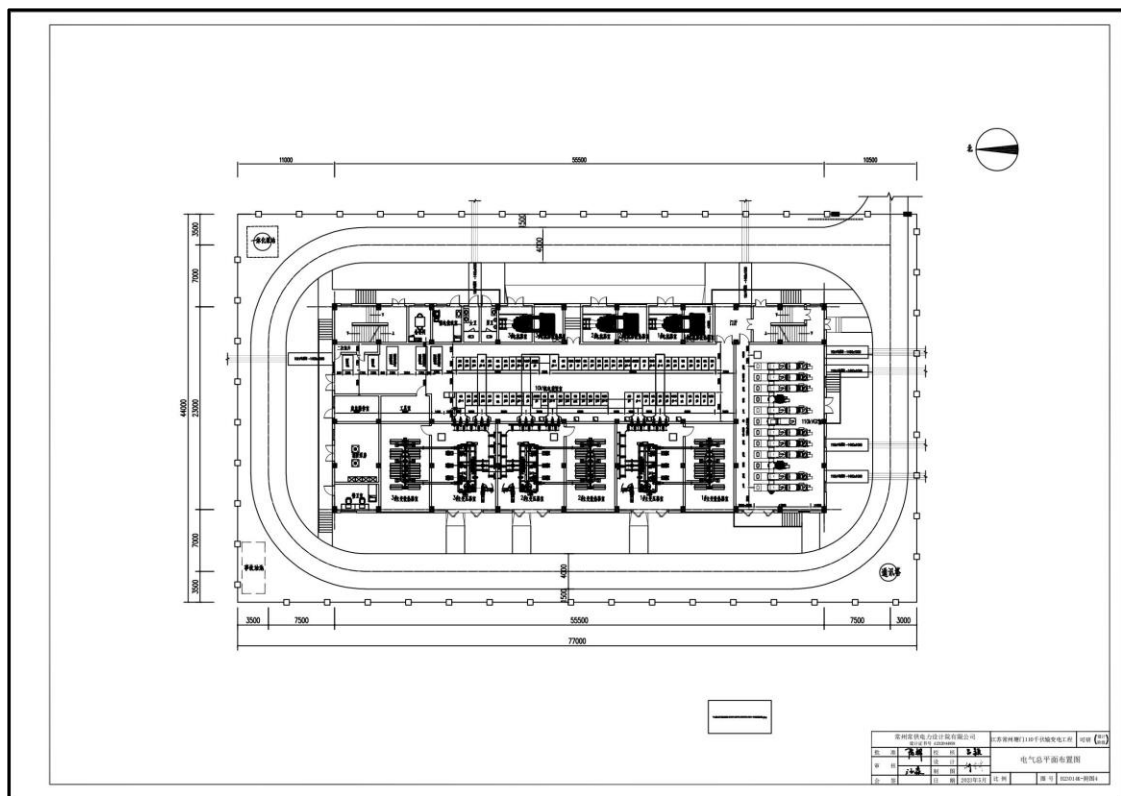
塘门 110kV 变电站工程总平面布置图
